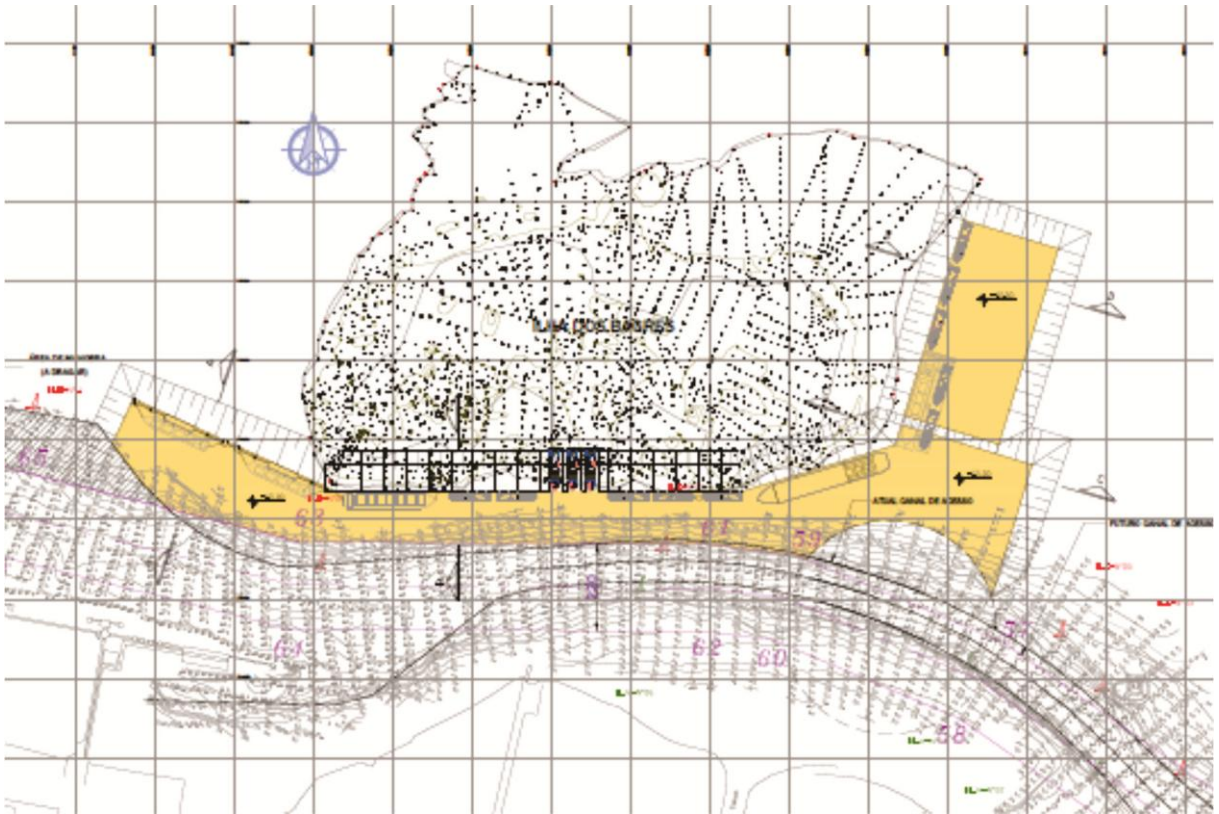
Planta de Dragagem do Projeto Conceitual
